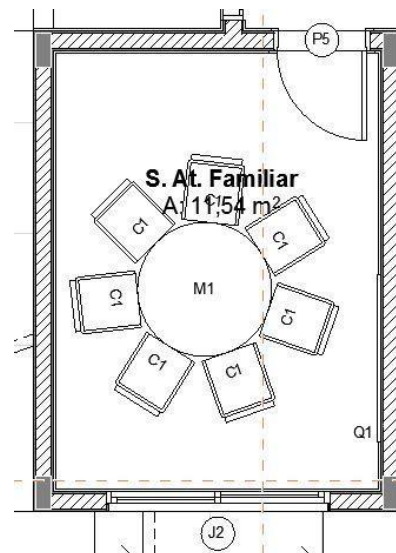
Planta baixa da Sala de Atendimento Familiar
